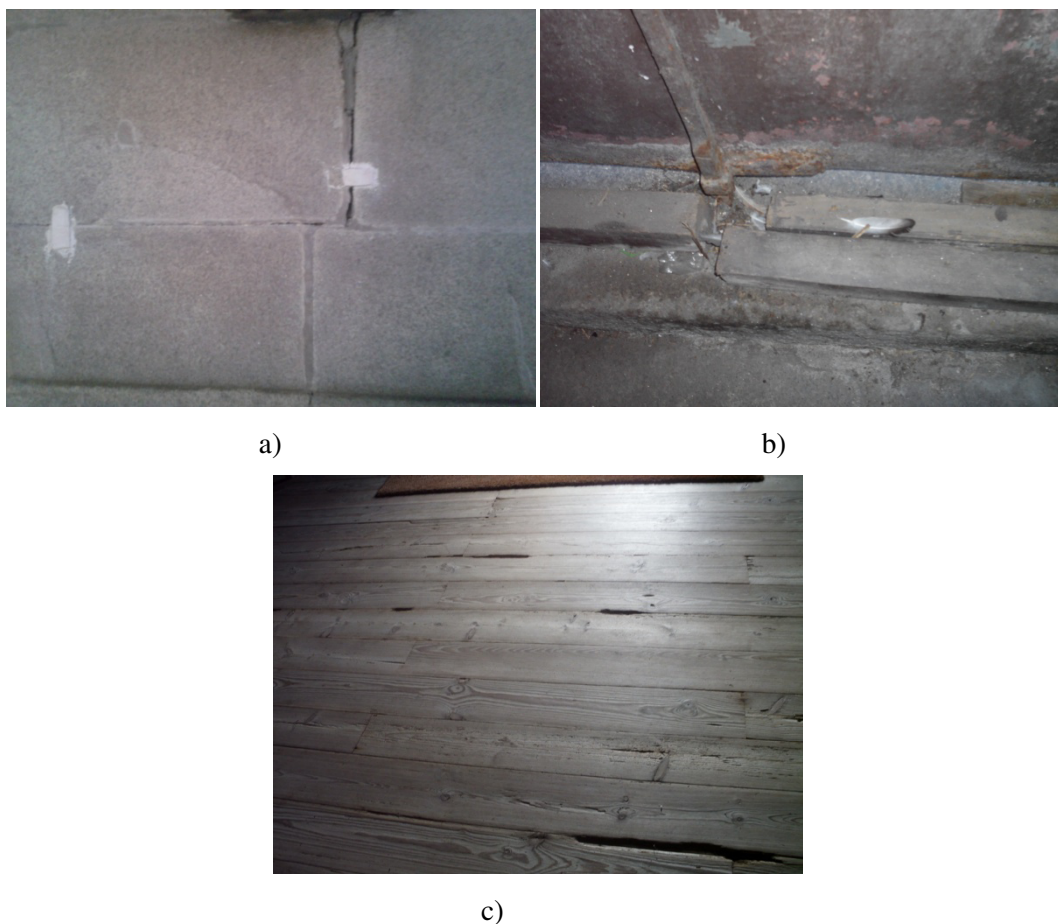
a) Fendas nas juntas – Igreja dos Grilos; b) Porta em mau estado, apresentando aberturas na parte inferior – Igreja de São Bento da Vitória; c) Pavimento de madeira com fendas – Igreja de São Cristovão de Rio Mau
